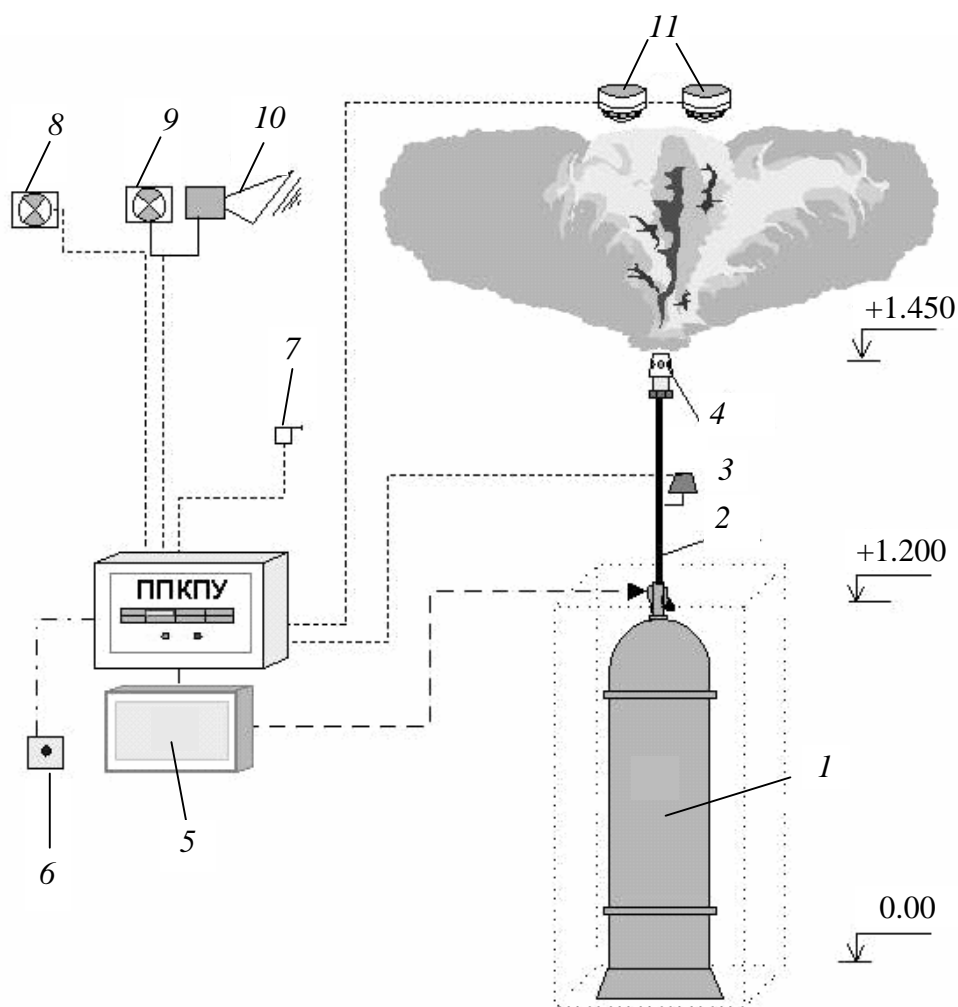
Схема модульной УАГП без трубной разводки:
